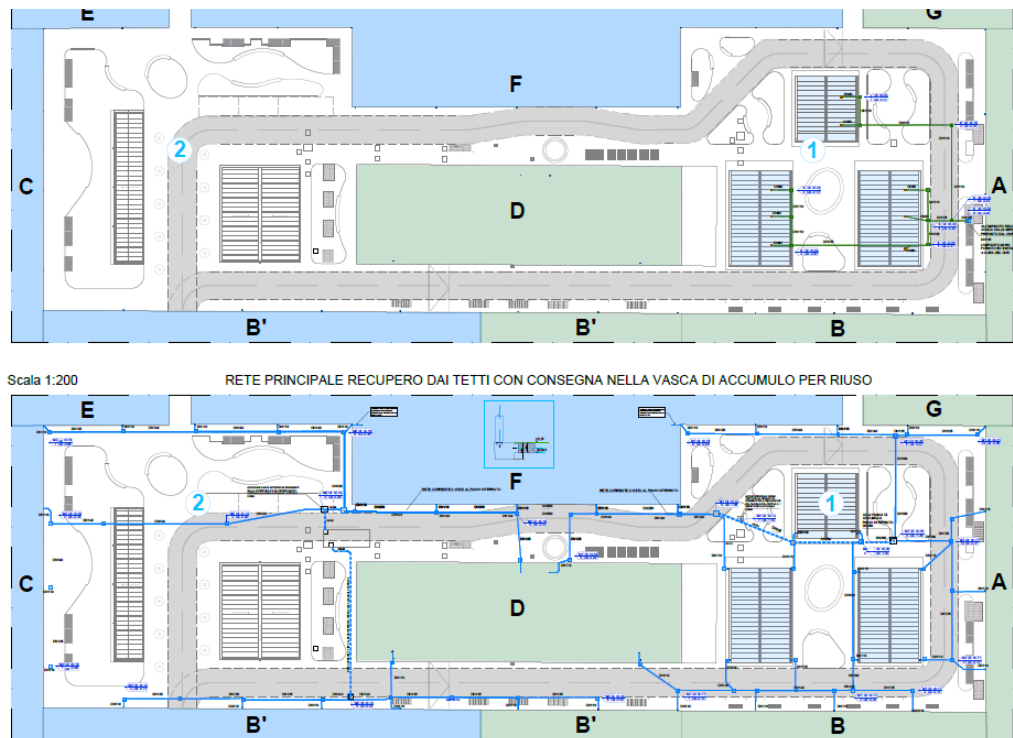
Reti recupero acque dalle serre e rete principale recupero dai tetti. Fonte: Caudai E., 2020
